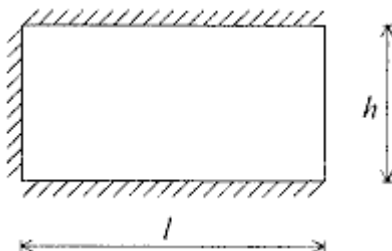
Стена, защемленная на уровне верхнего и нижнего перекрытий и у одного вертикального края
